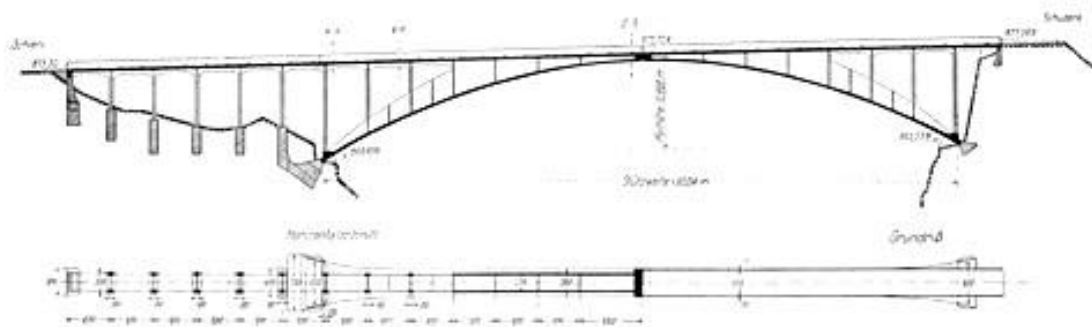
Plano donde se aprecian los elementos de cimentación de los pilares de apoyo de la zona izquierda del tablero.
